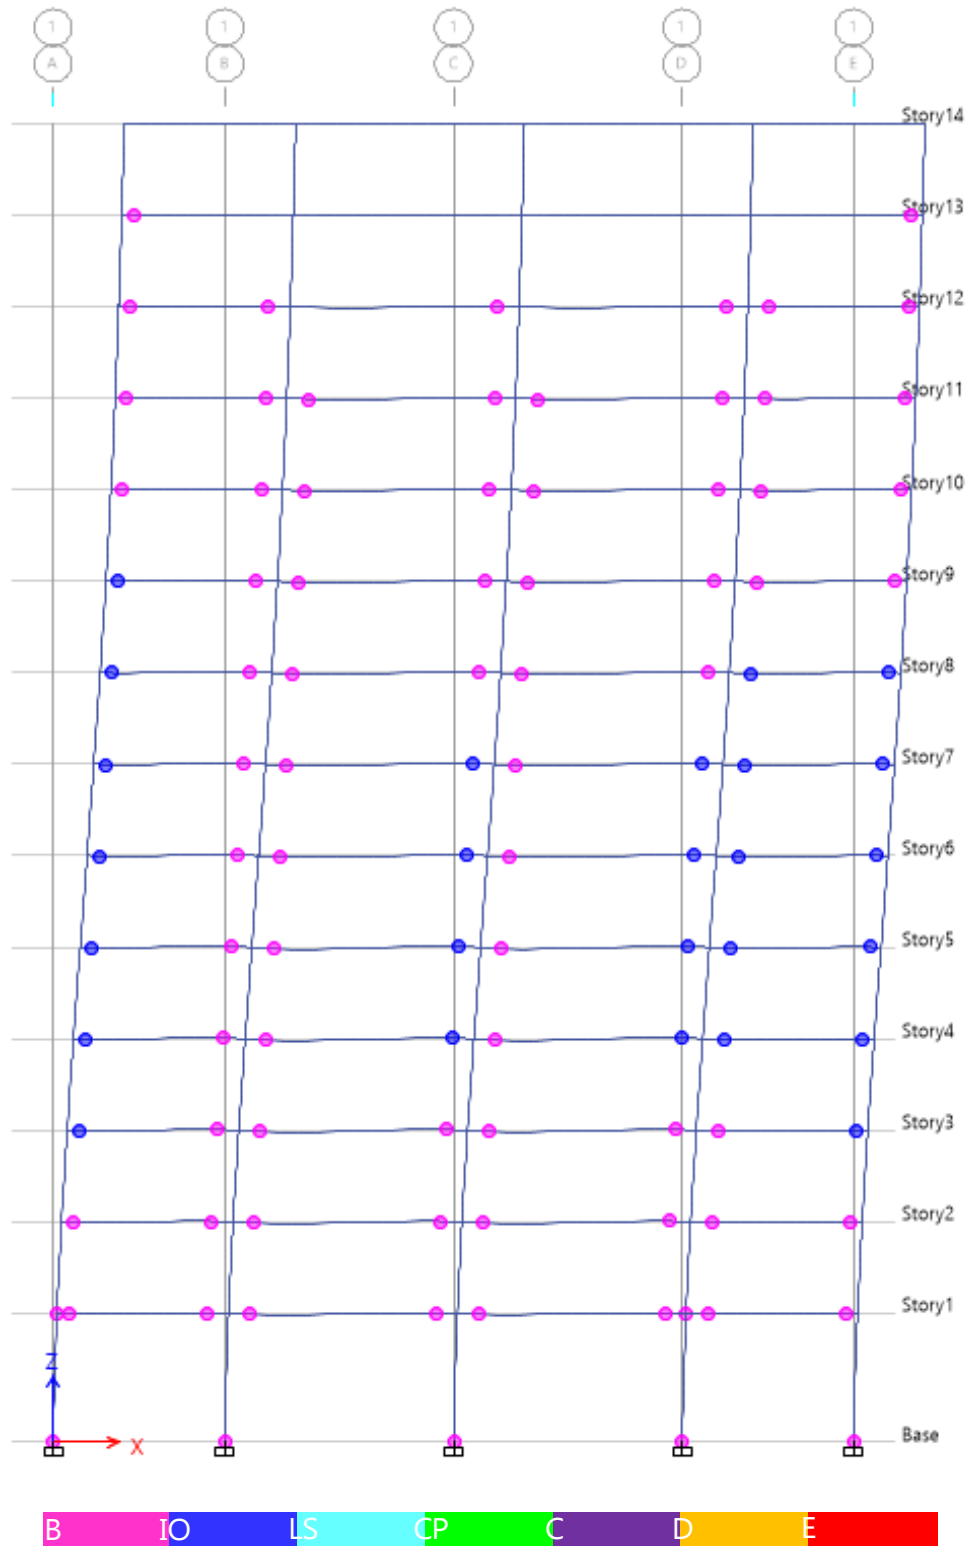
Formulación rótulas plásticas Eje 2 para BSE-1 en dirección x (Pórtico a momento hormigón armado ASCE 7-10).
